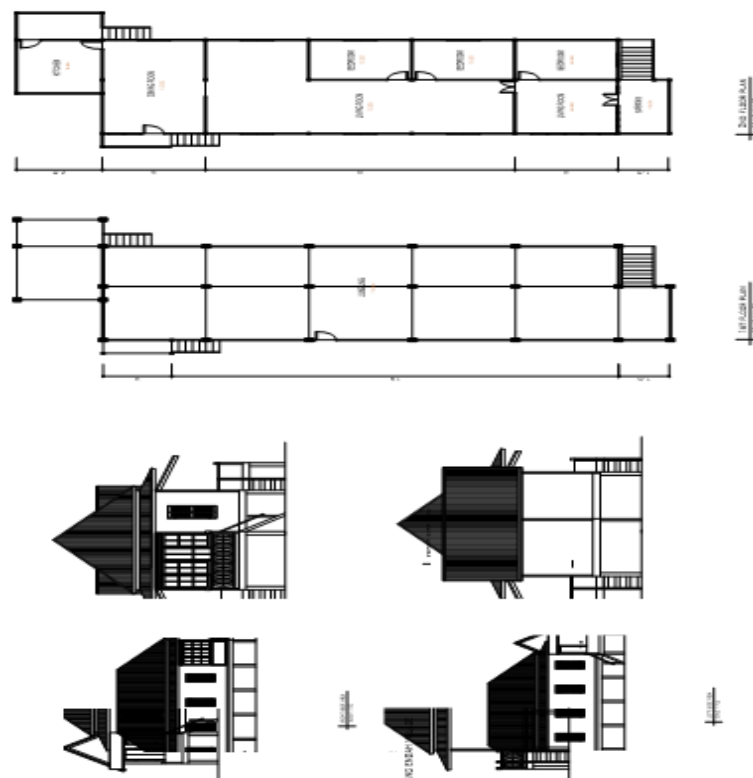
Rumah Baghi Building Plans at Tinggi Hari village
